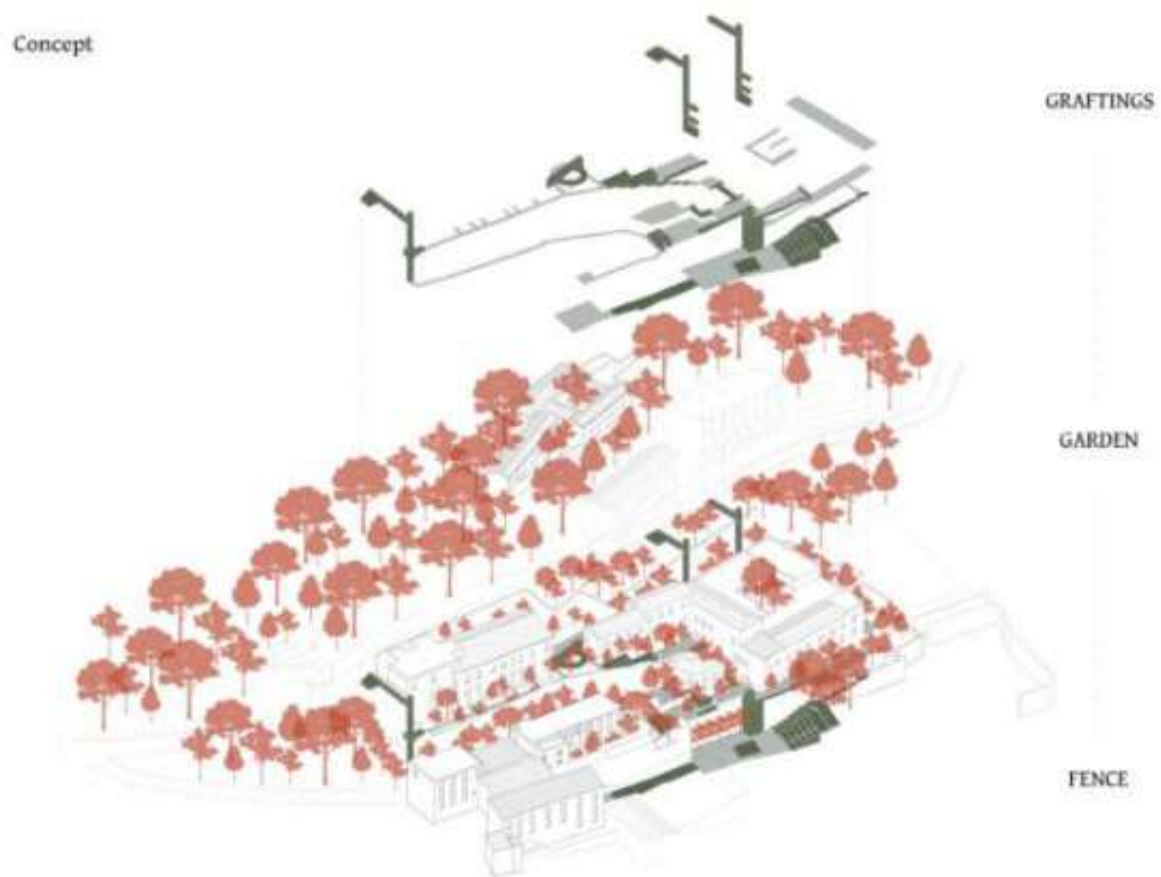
Assonometria esplosa di progetto (elaborazione dell'autore).
